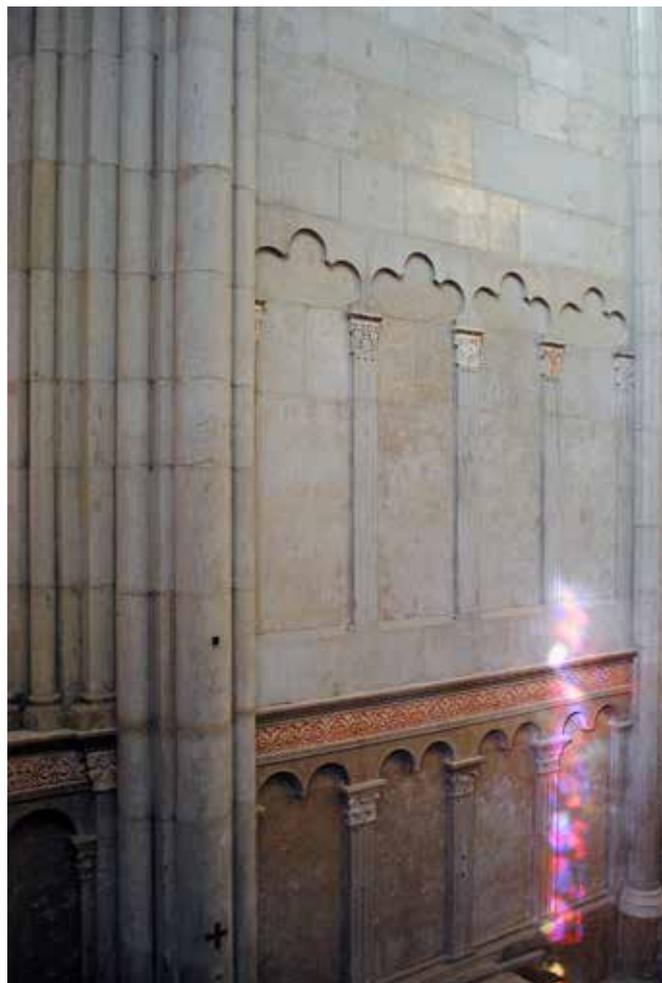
Chœur, travée B sud (UM 3), arcature trilobée, pilastre médian ouest, tentative d'adoucissement des angles de la base en décalage avec le pilastre qui la surmonte.
